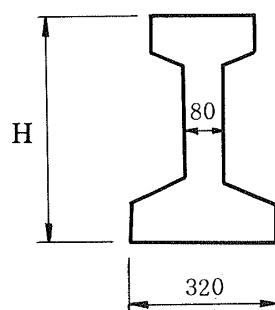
スラブ橋用PC橋げた¹⁸⁾
